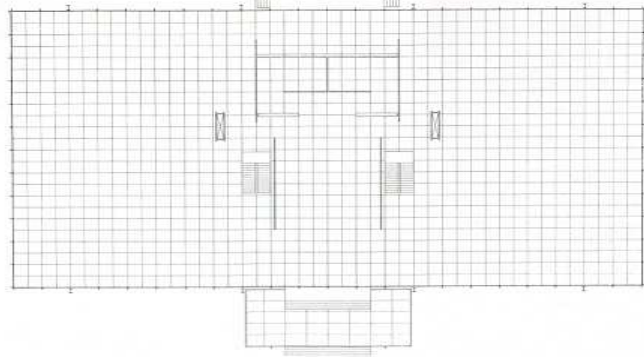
Crown Hall (planta do pavimento térreo), 1952
